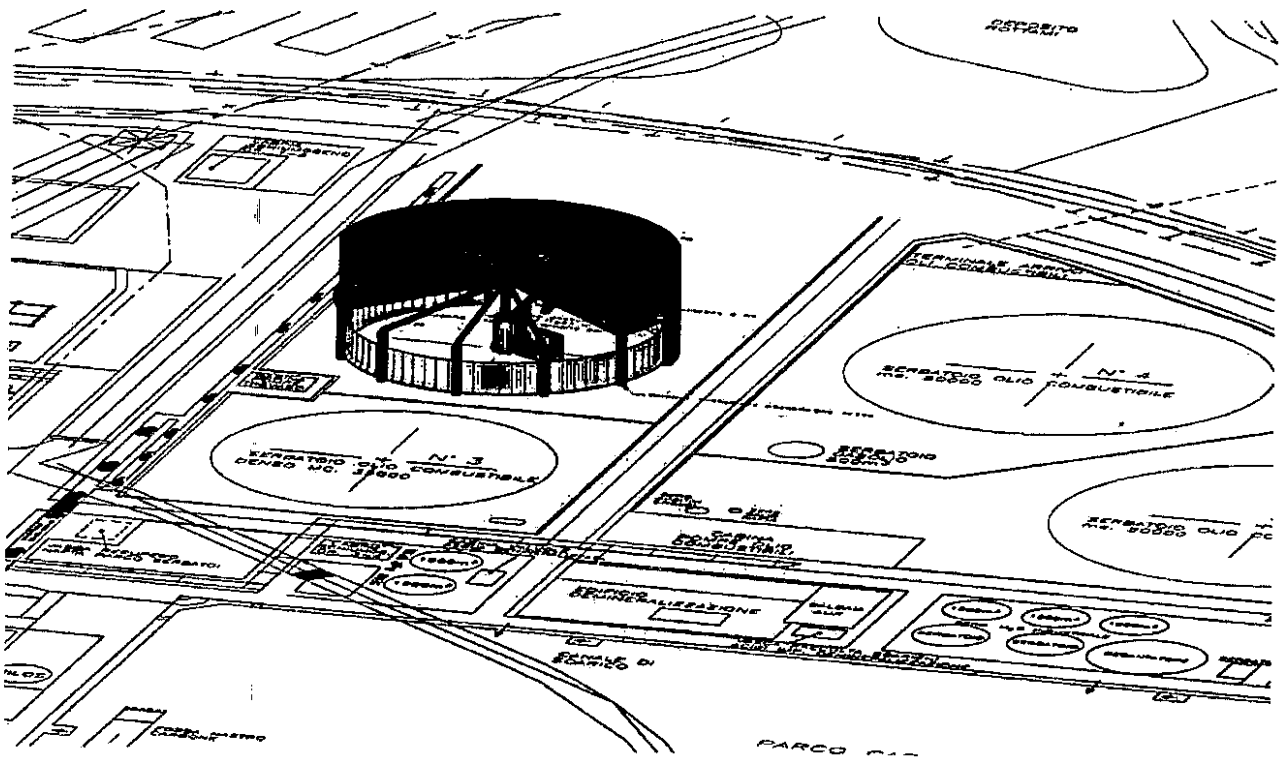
Planimetria 3D del serbatoio num. 2 con volumi di accumulo
